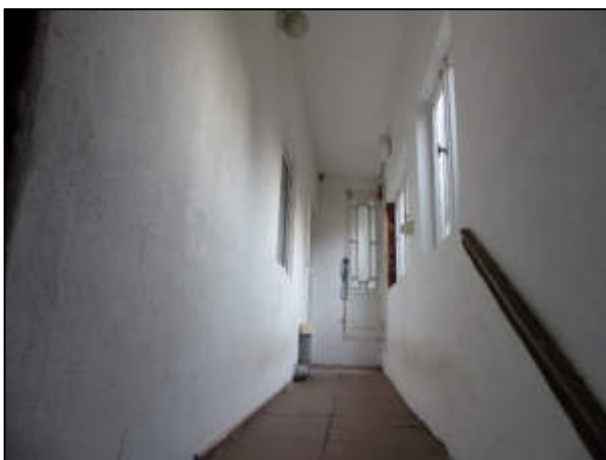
1. OG – Laubengang mit separatem Zugang zur WE 5
